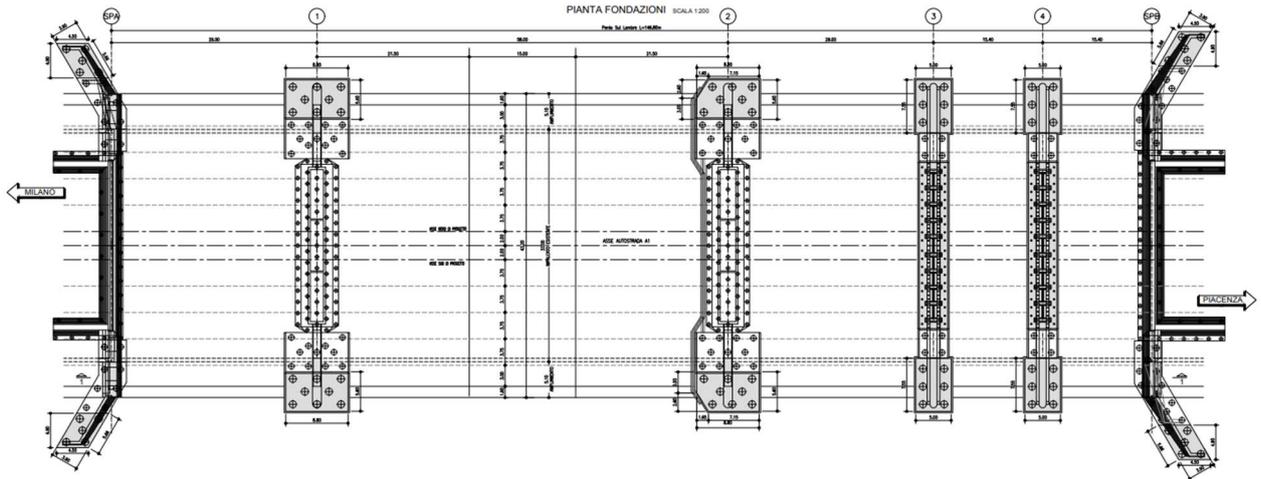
Pianta fondazioni Viadotto Lambro – configurazione approvata
